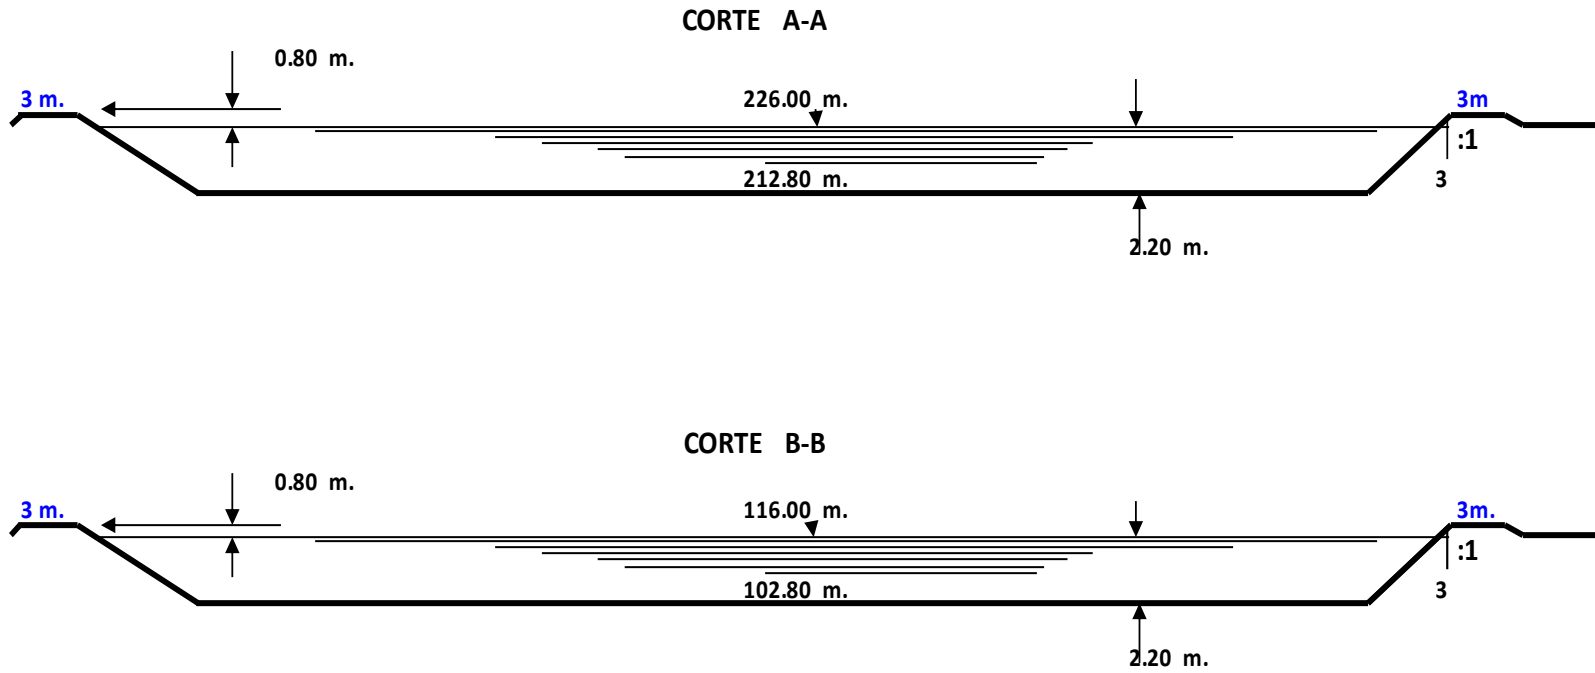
Dimensiones laguna secundaria – Detalle en Corte
